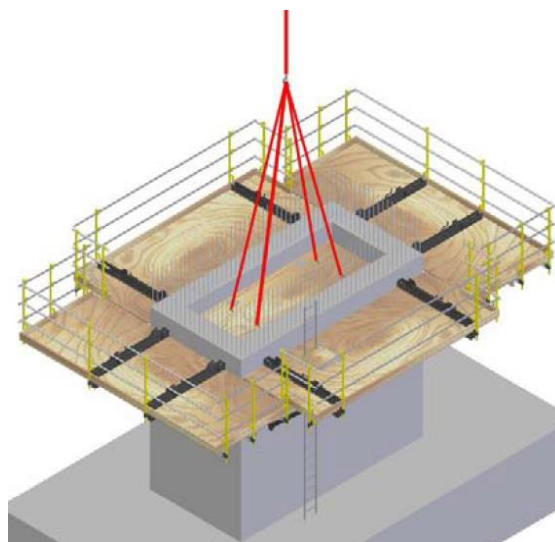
t. Detalle de colocación de plataforma interior abatible. Recuperado de: Ulma Construction,
